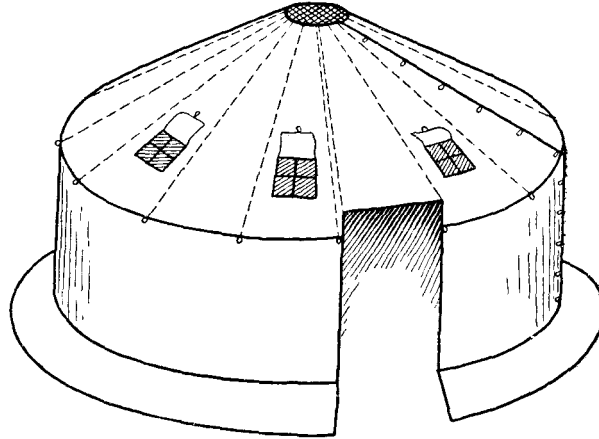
Общий вид развернутого покрытия тордоха (чума)
